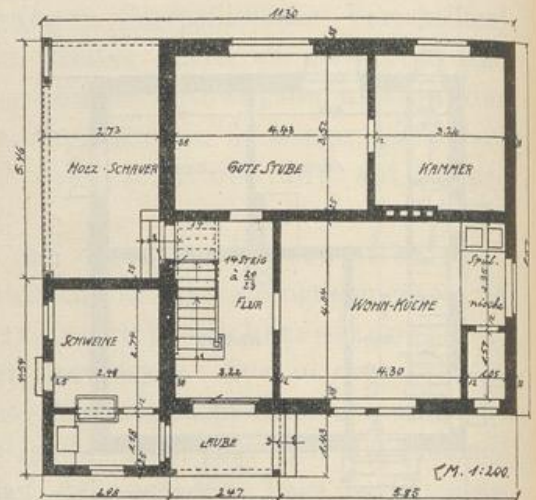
Arbeiterwohnhaus auf dem Lande mit Stall für Schweine. daneben Holzschauer. Abort von der Eingangslaube zugänglich. Wohnküche mit Spülnische.
